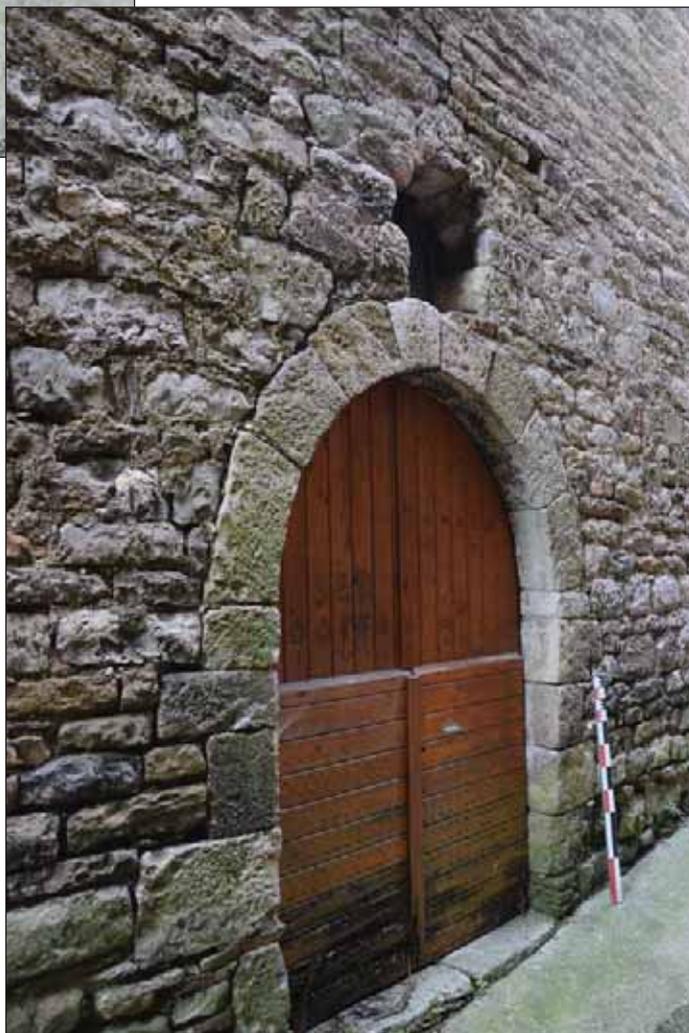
fente de jour du rez-de-chaussée et angle oriental arraché
